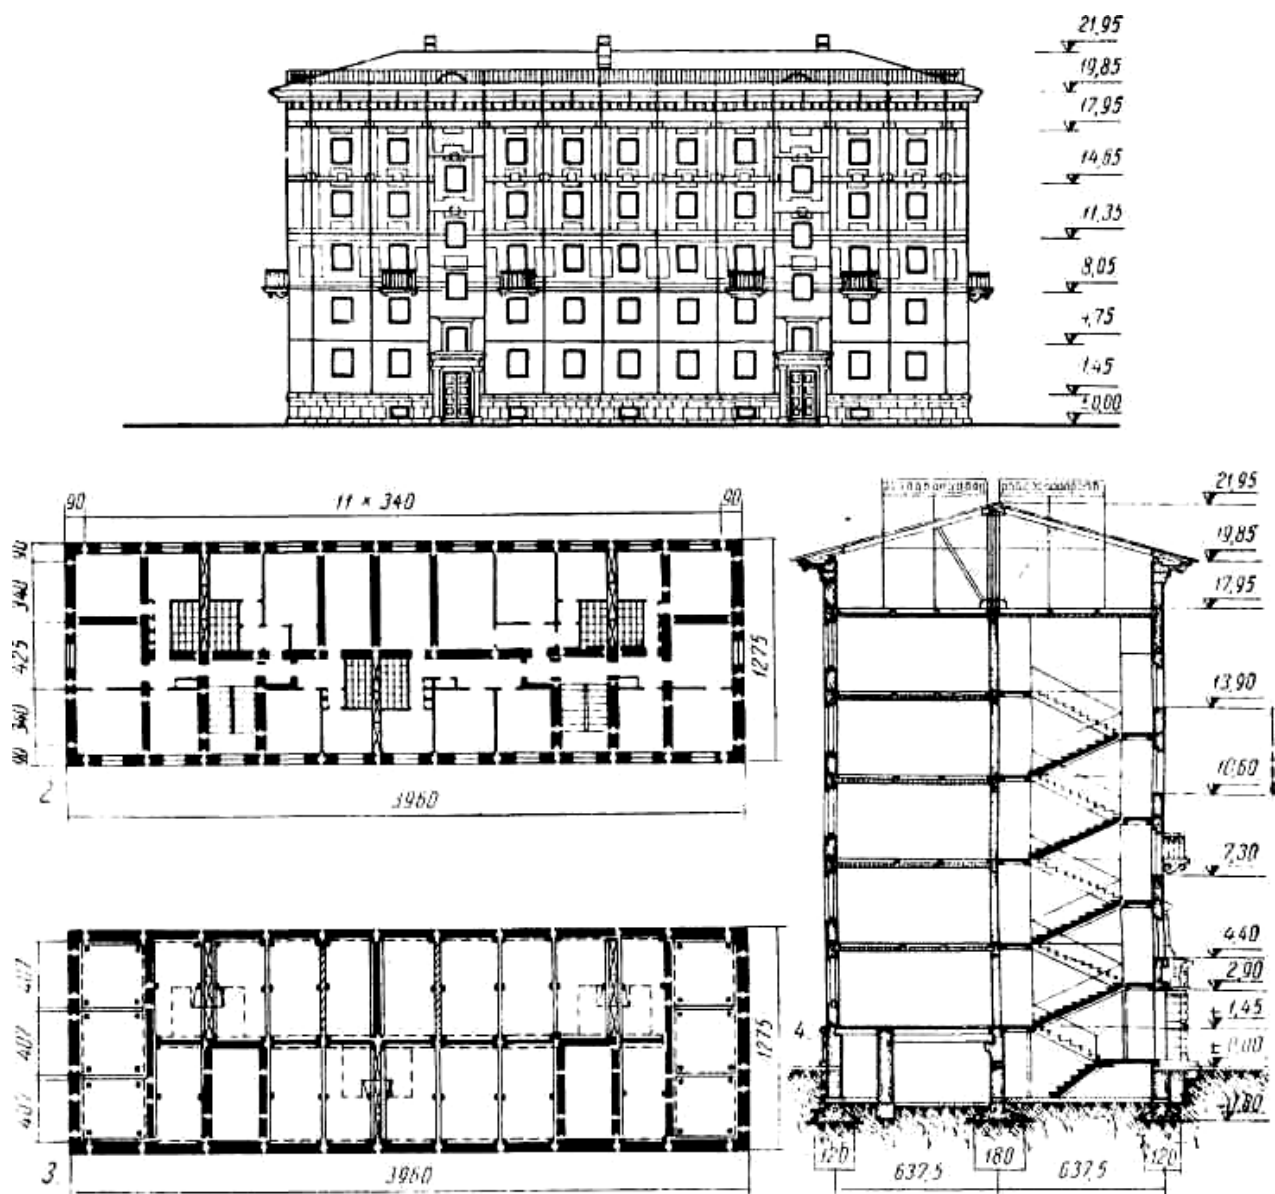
Проект першого великопанельного житлового будинку, побудованого на Щеміловке в Невському районі. Фасад, плани, розріз
